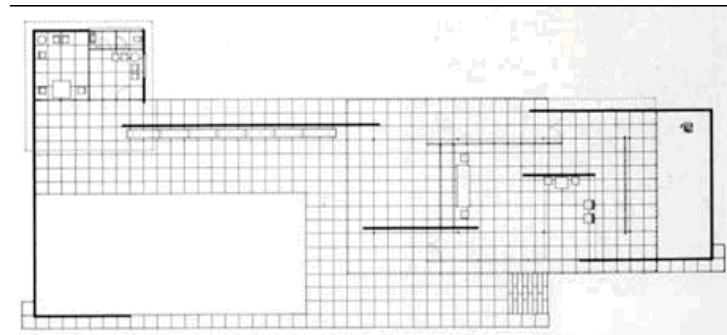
Fundação Mies van der Rohe, Barcelona - Planta do Pavilhão de Barcelona. Fonte: Souza, [s.d.].
